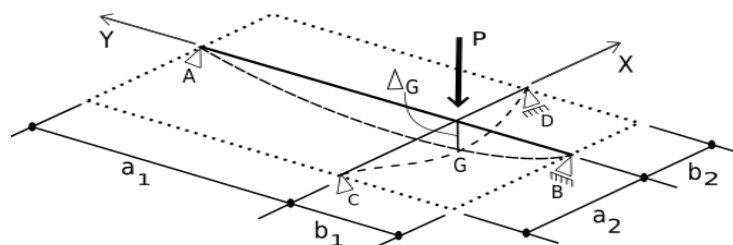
Detalhamento de aplicação da carga na grelha de duas vigas (Adaptado de Stucchi, 2006).
